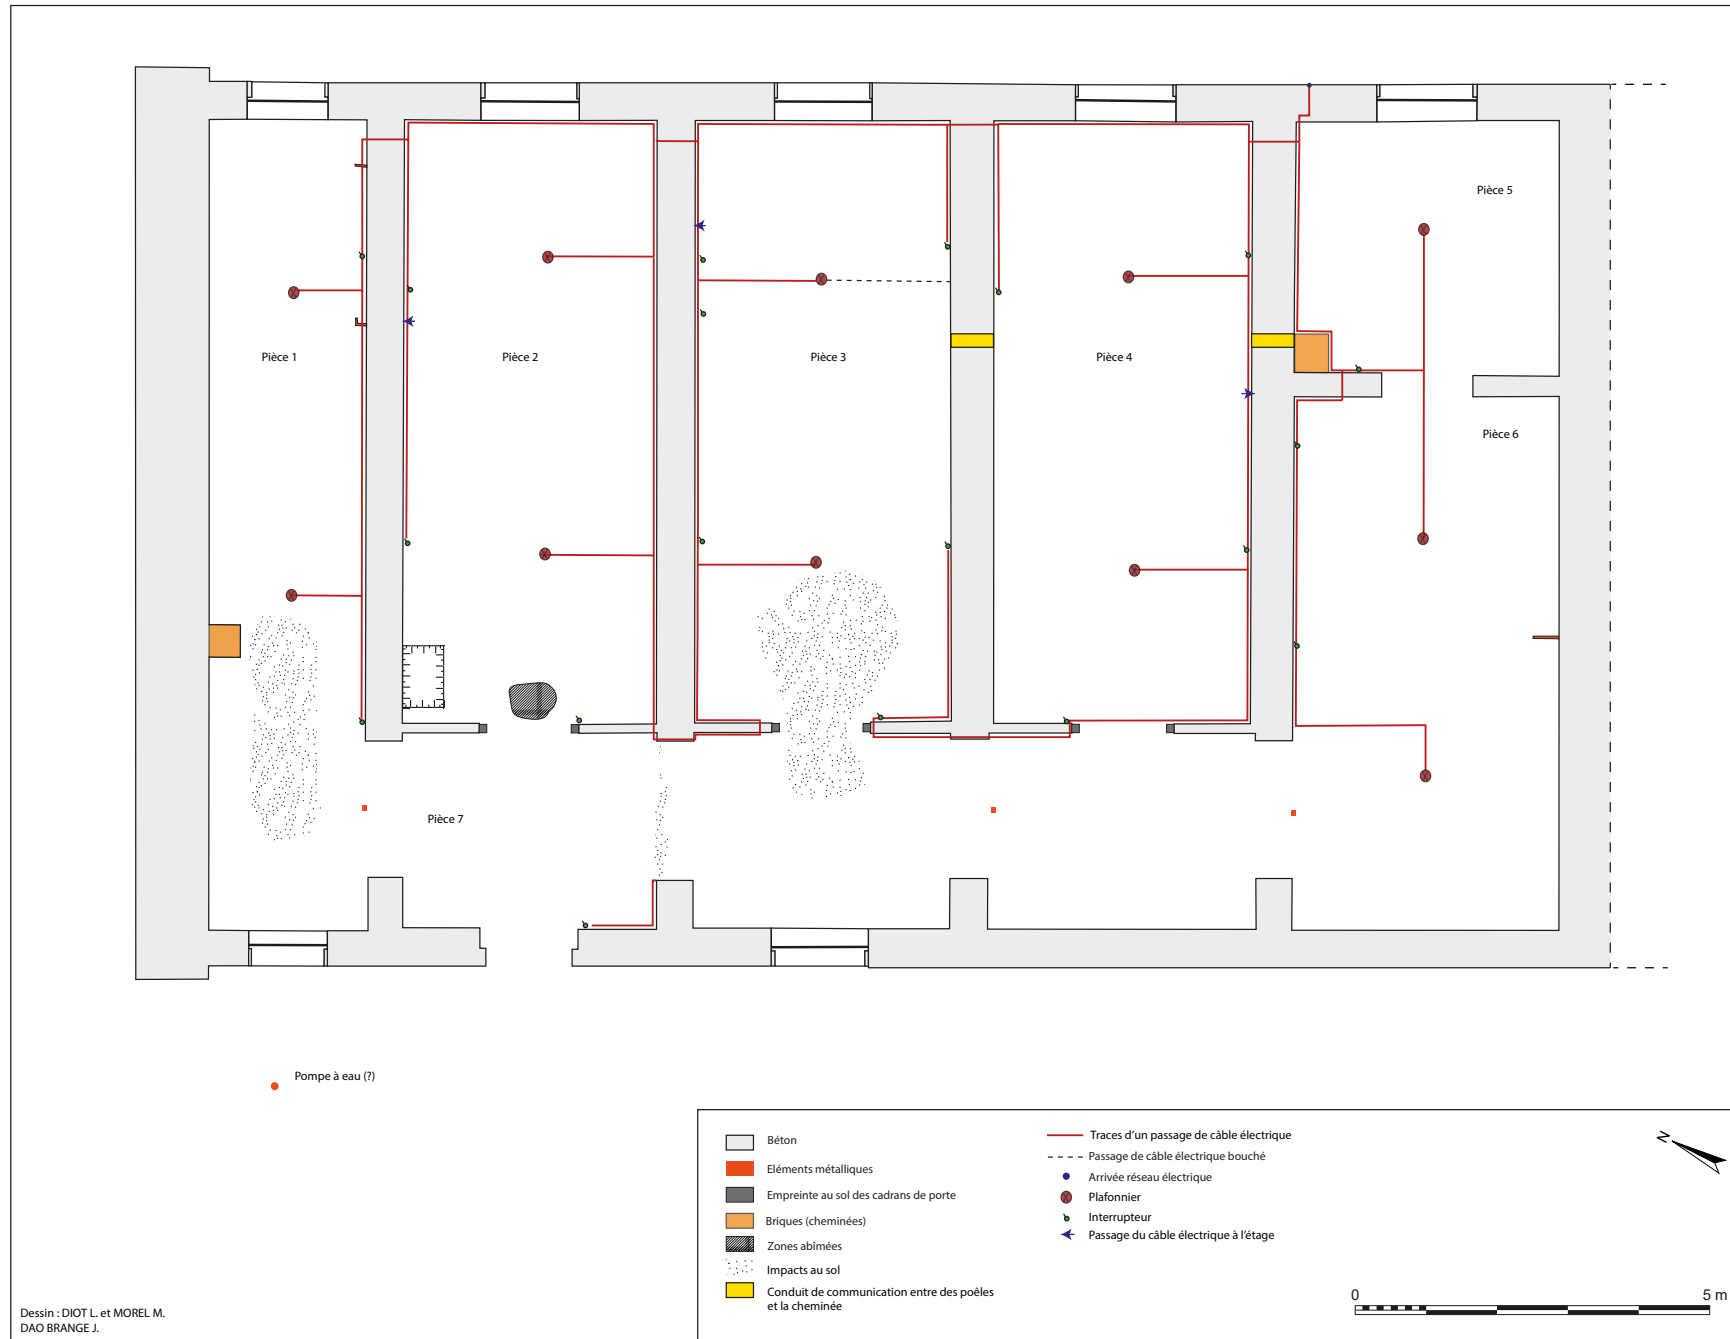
Plan du rez-de-chaussée de la forge et restitution du réseau électrique (J. Brangé).
